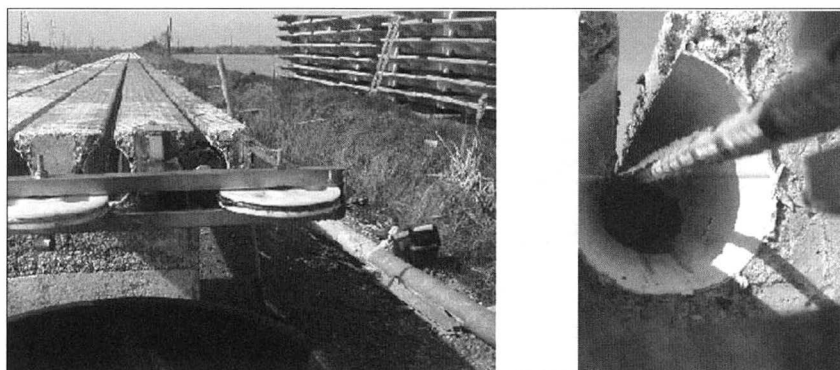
Pavimentazione fessurata con tubazioni e sistema meccanico proposto per il rapido allontanamento delle deiezioni
